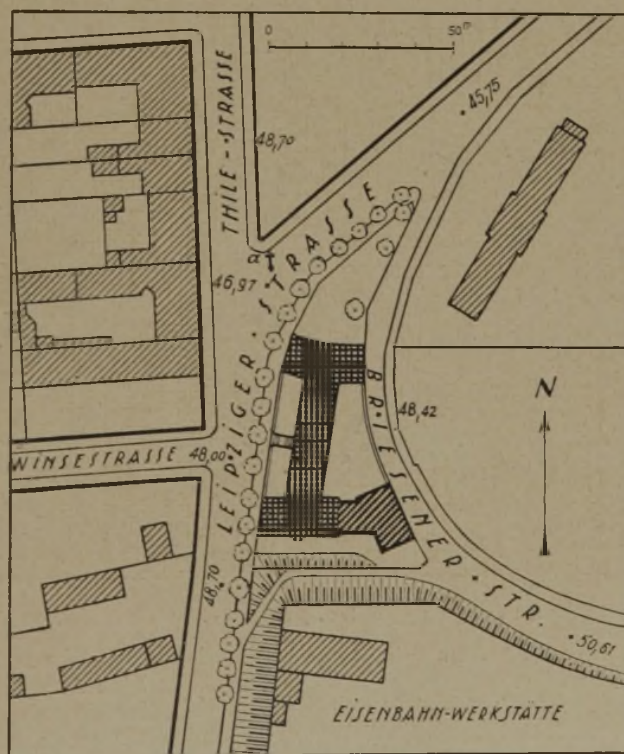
Lageplan der Hausgruppe Leipziger-Strasse,
